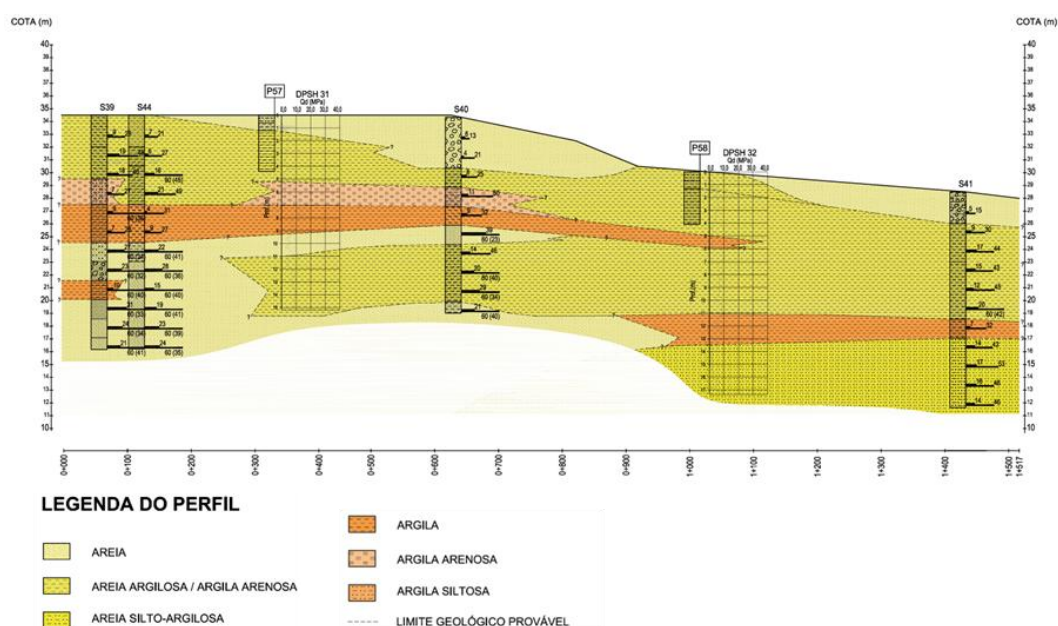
Perfil geológico – geotécnico N-S da zona central do terreno de implantação da central solar
